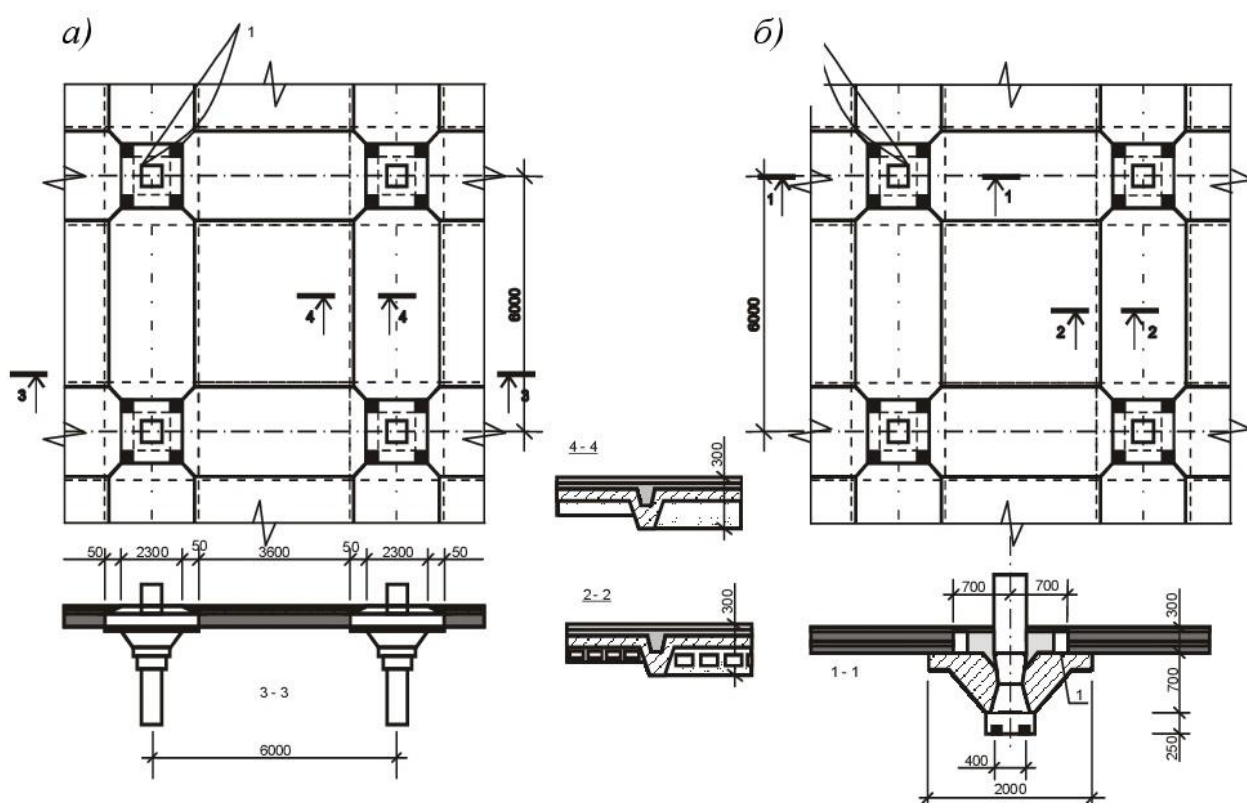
Фрагмент збірного безбалкового перекриття
